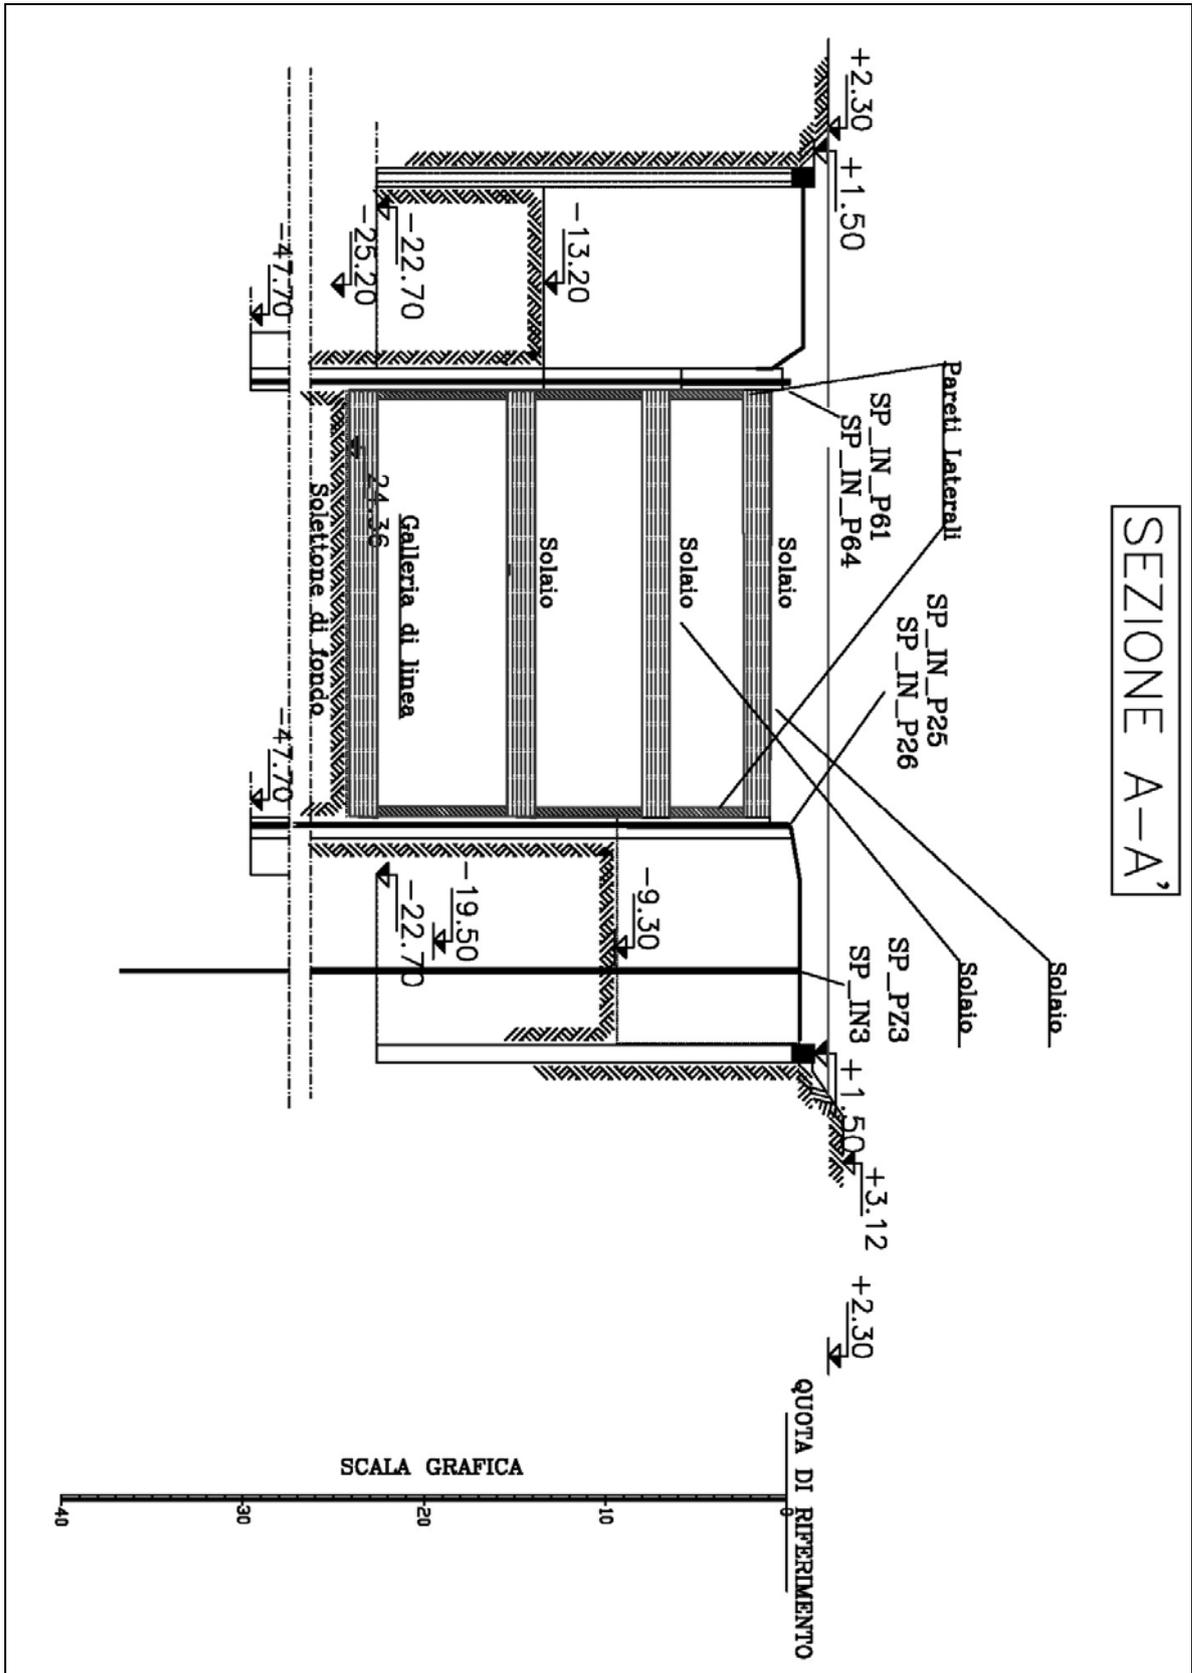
Sezione A-A' pozzo stazione, raffigurante la suddivisione in aree di lavoro.
